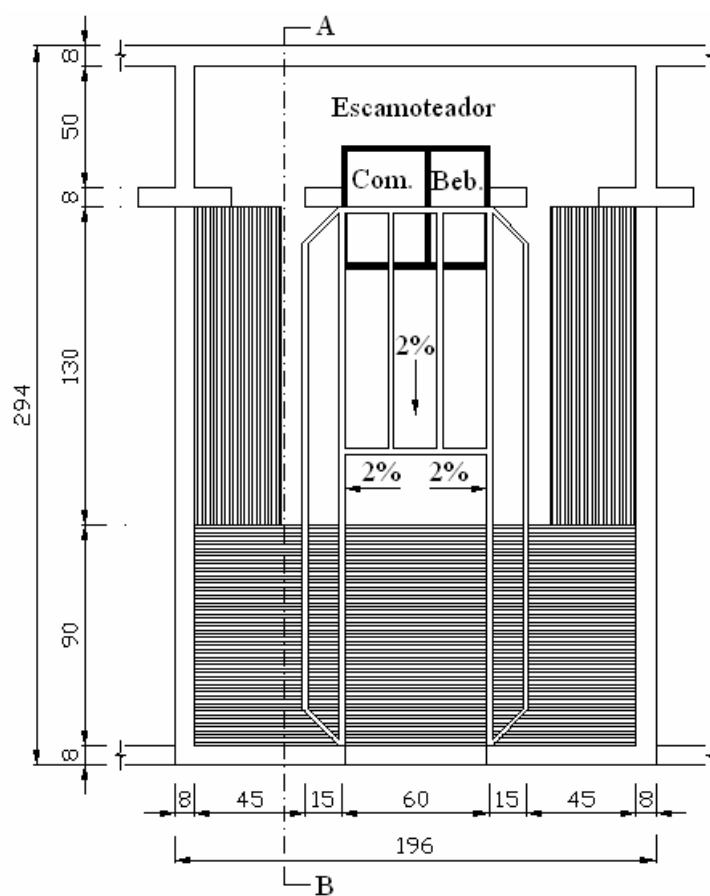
Planta baixa de uma típica gaiola de parição com escamoteador (sem escala, cotas em cm)
